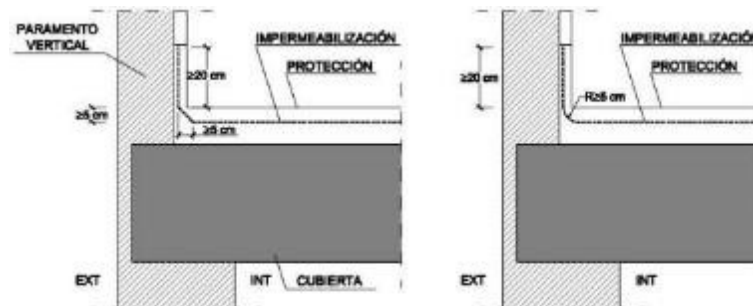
Encuentro de la cubierta con un paramento vertical
